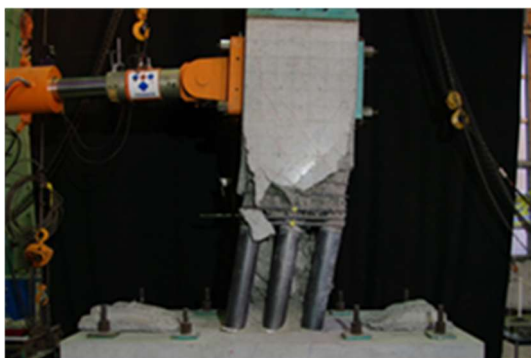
10  $\delta_y$  時の変形状況 (試験体 No. 2)
